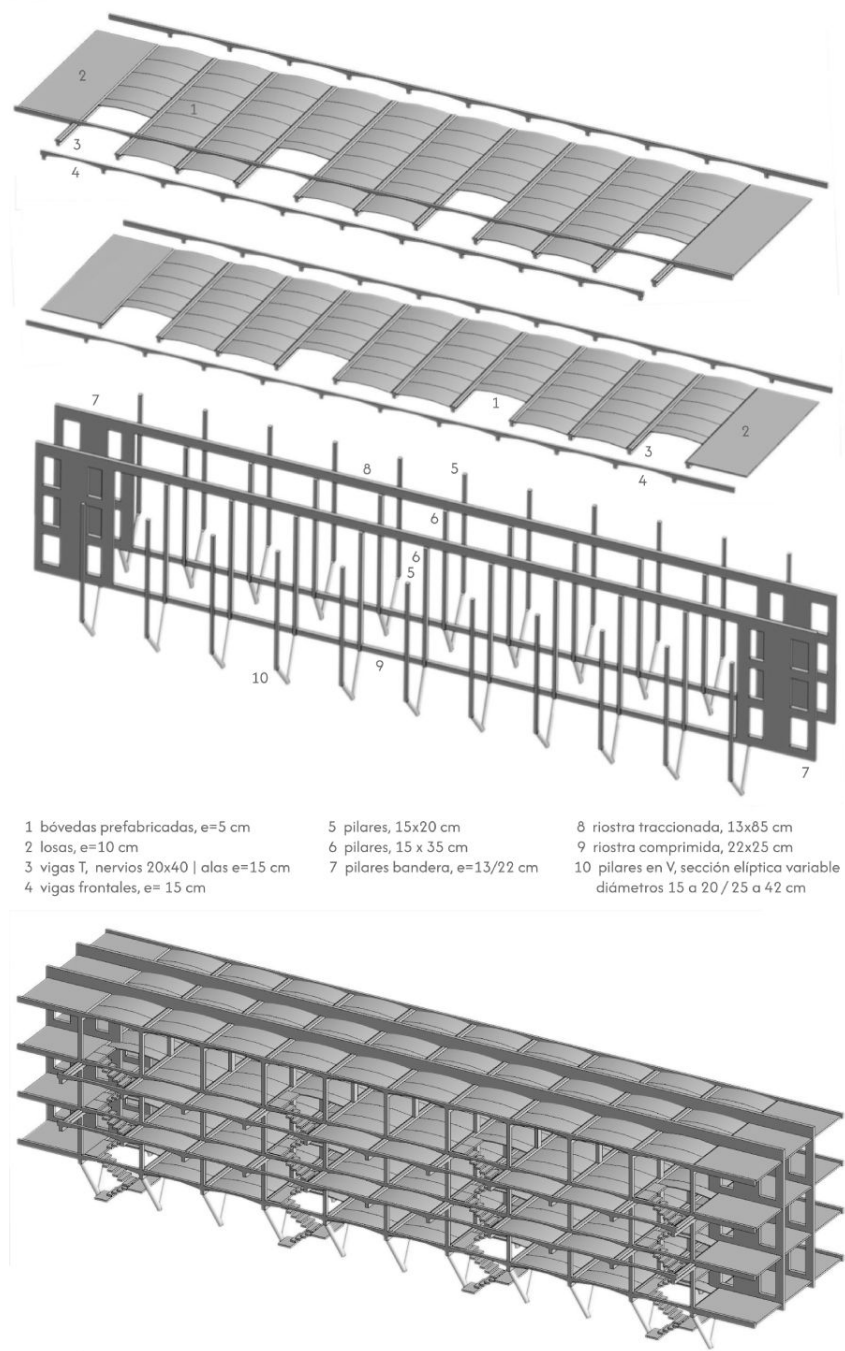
Axonometrías estructurales del Ruca Malén: plantas tipo, soportes y vista del conjunto.
